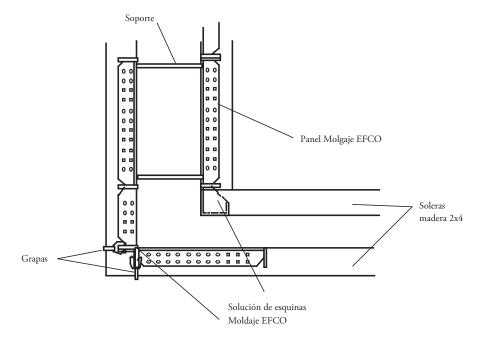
Vista de planta de muro con moldaje EFCO.
